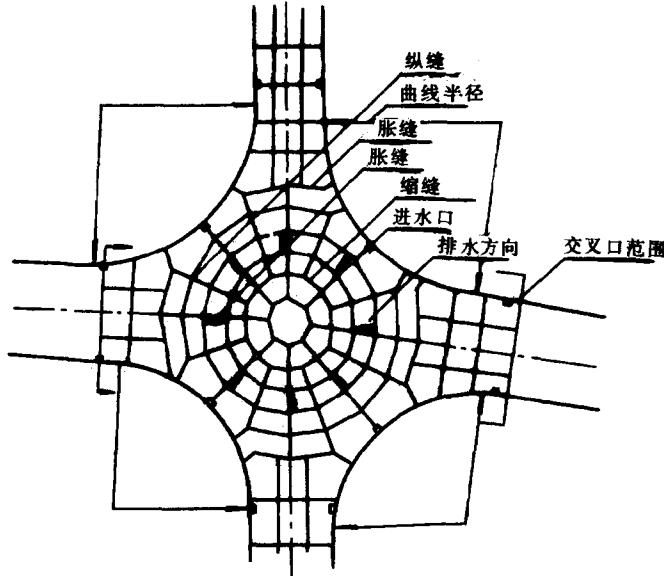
水泥混凝土路面交叉口划块布置图(辐射式)
